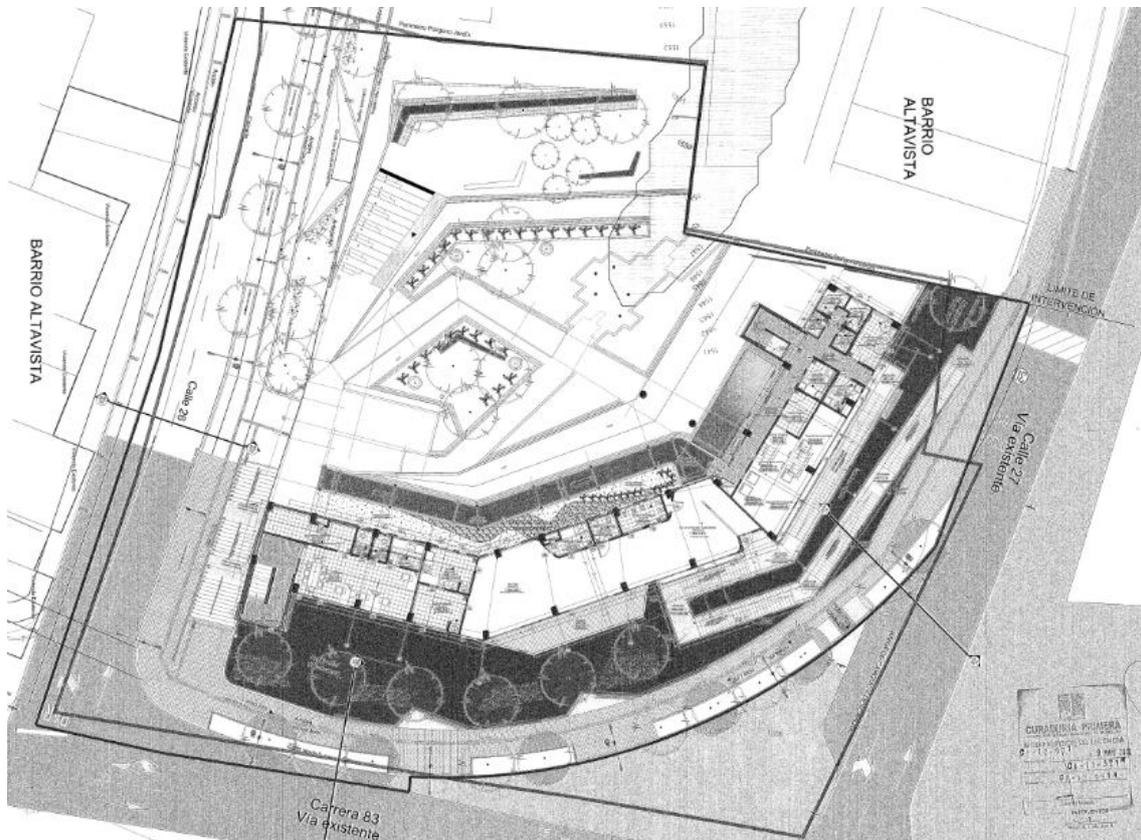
Jardín Infantil Altavista en el Barrio Belén.
